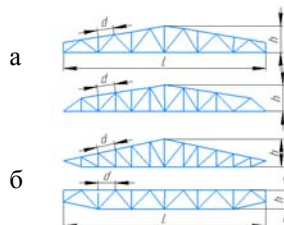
Схеми ферм: а – стропильні; б – кранові
